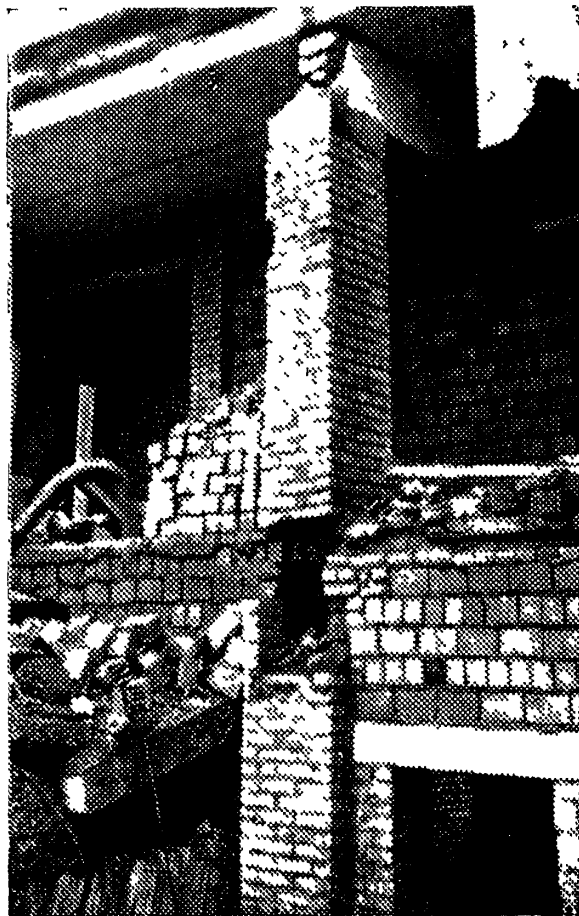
Разрушение в месте опирания железобетонной подушки на кирпичный столб
